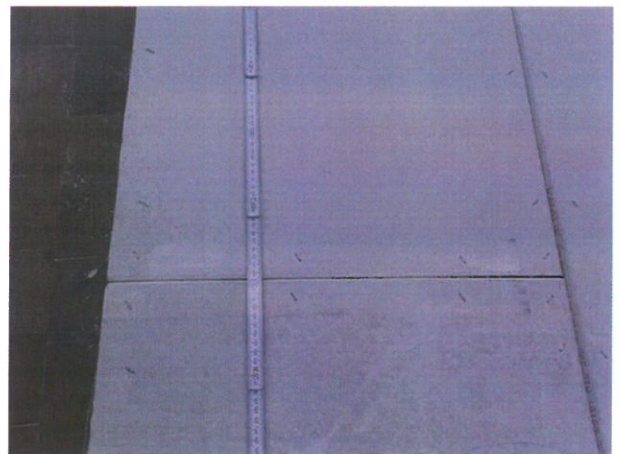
Horizontalstoß der Feuerschutzplatten.
